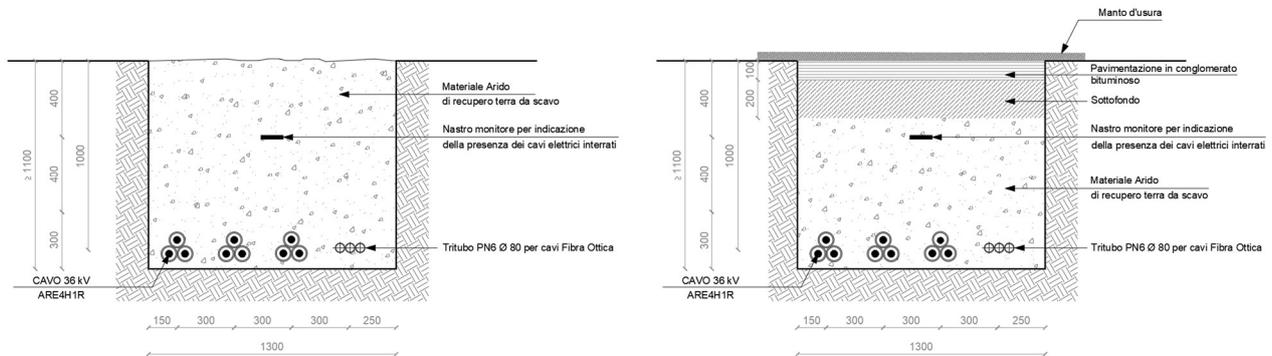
Tipica modalità di posa cavidotto 36 kV di collegamento alla RTN
